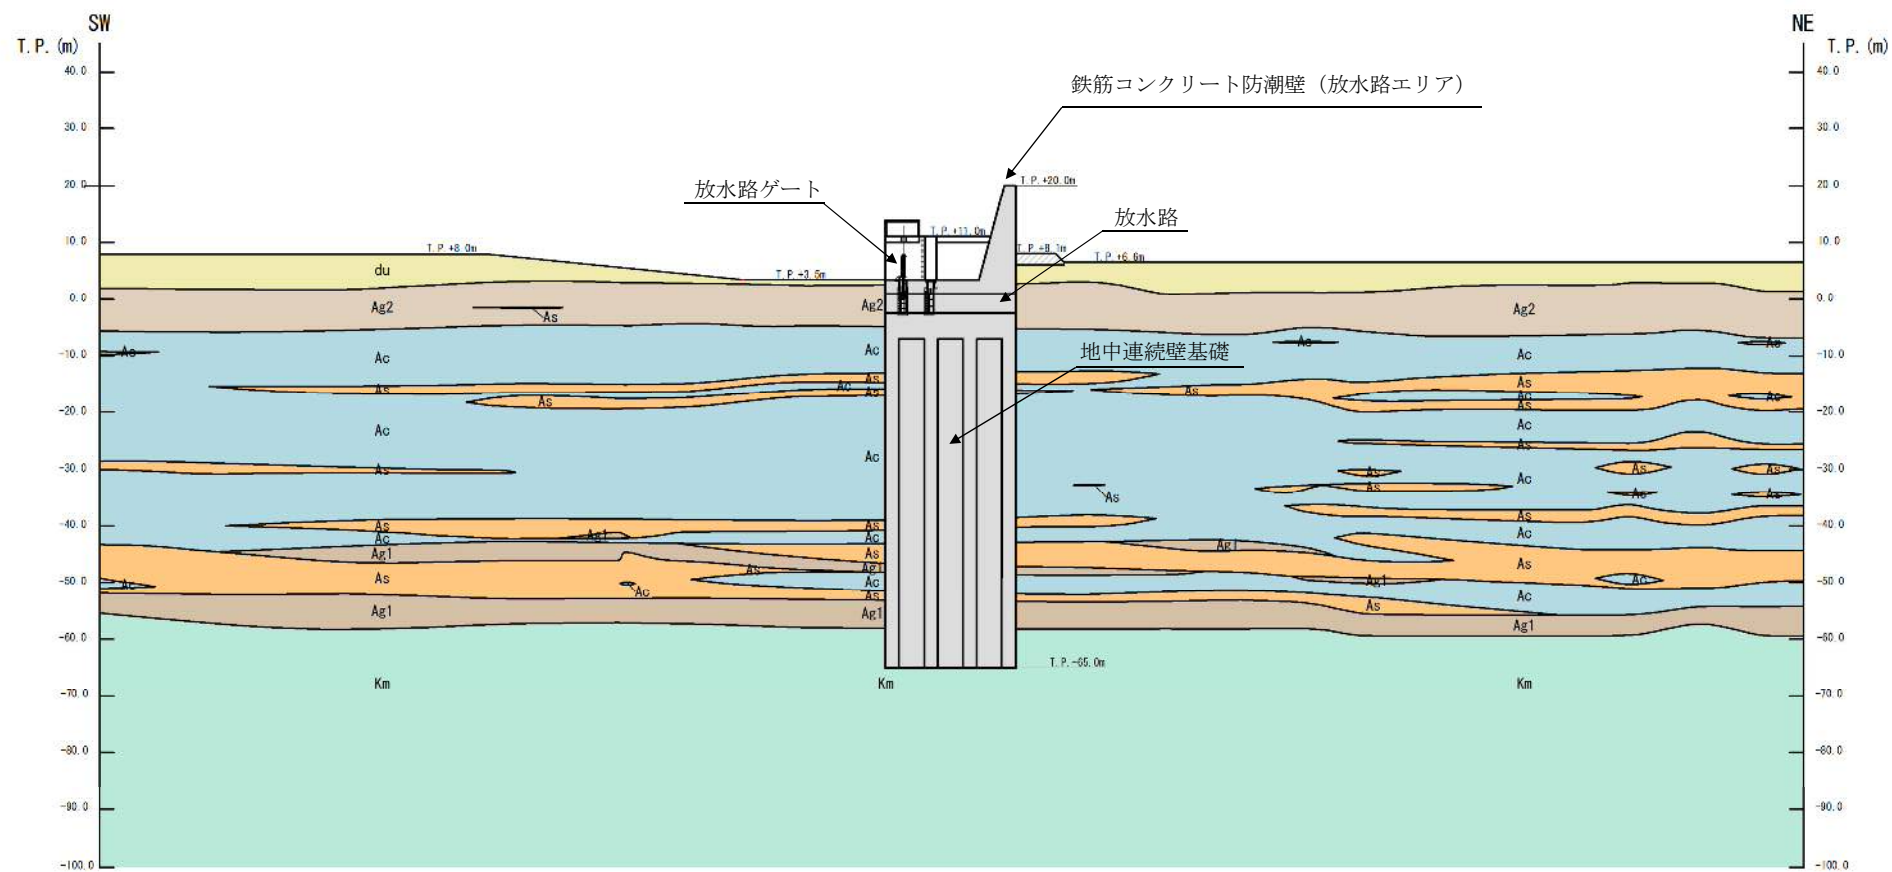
(1) 鉄筋コンクリート防潮壁（放水路エリア）の評価対象断面図（防潮壁横断方向：①-①断面）
